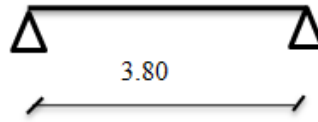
Poutrelle type 03 Plancher RDC (terrasse accessible)
